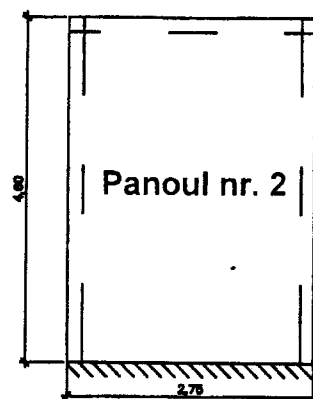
Panourile de placă luate în considerare la calculul plăcii planșeului
